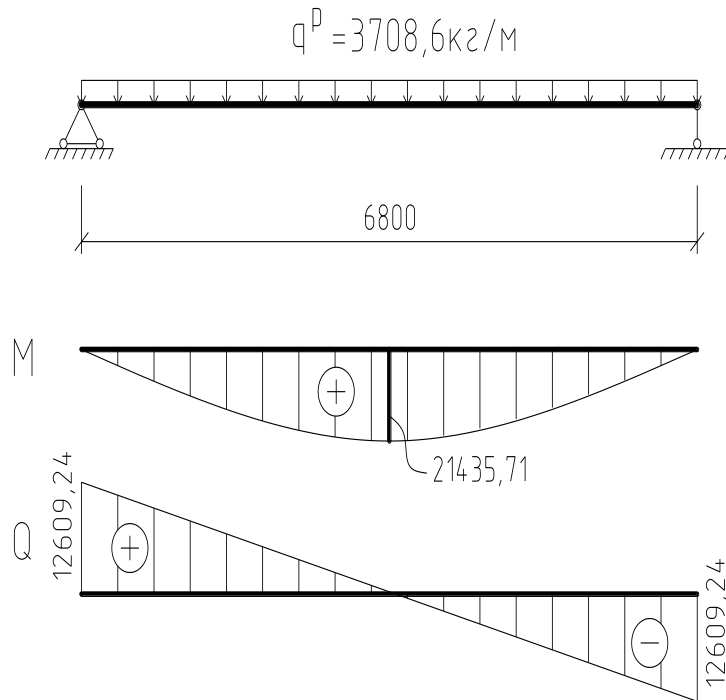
Побудова епюри сил і моментів, що діють на ригель перекриття.
